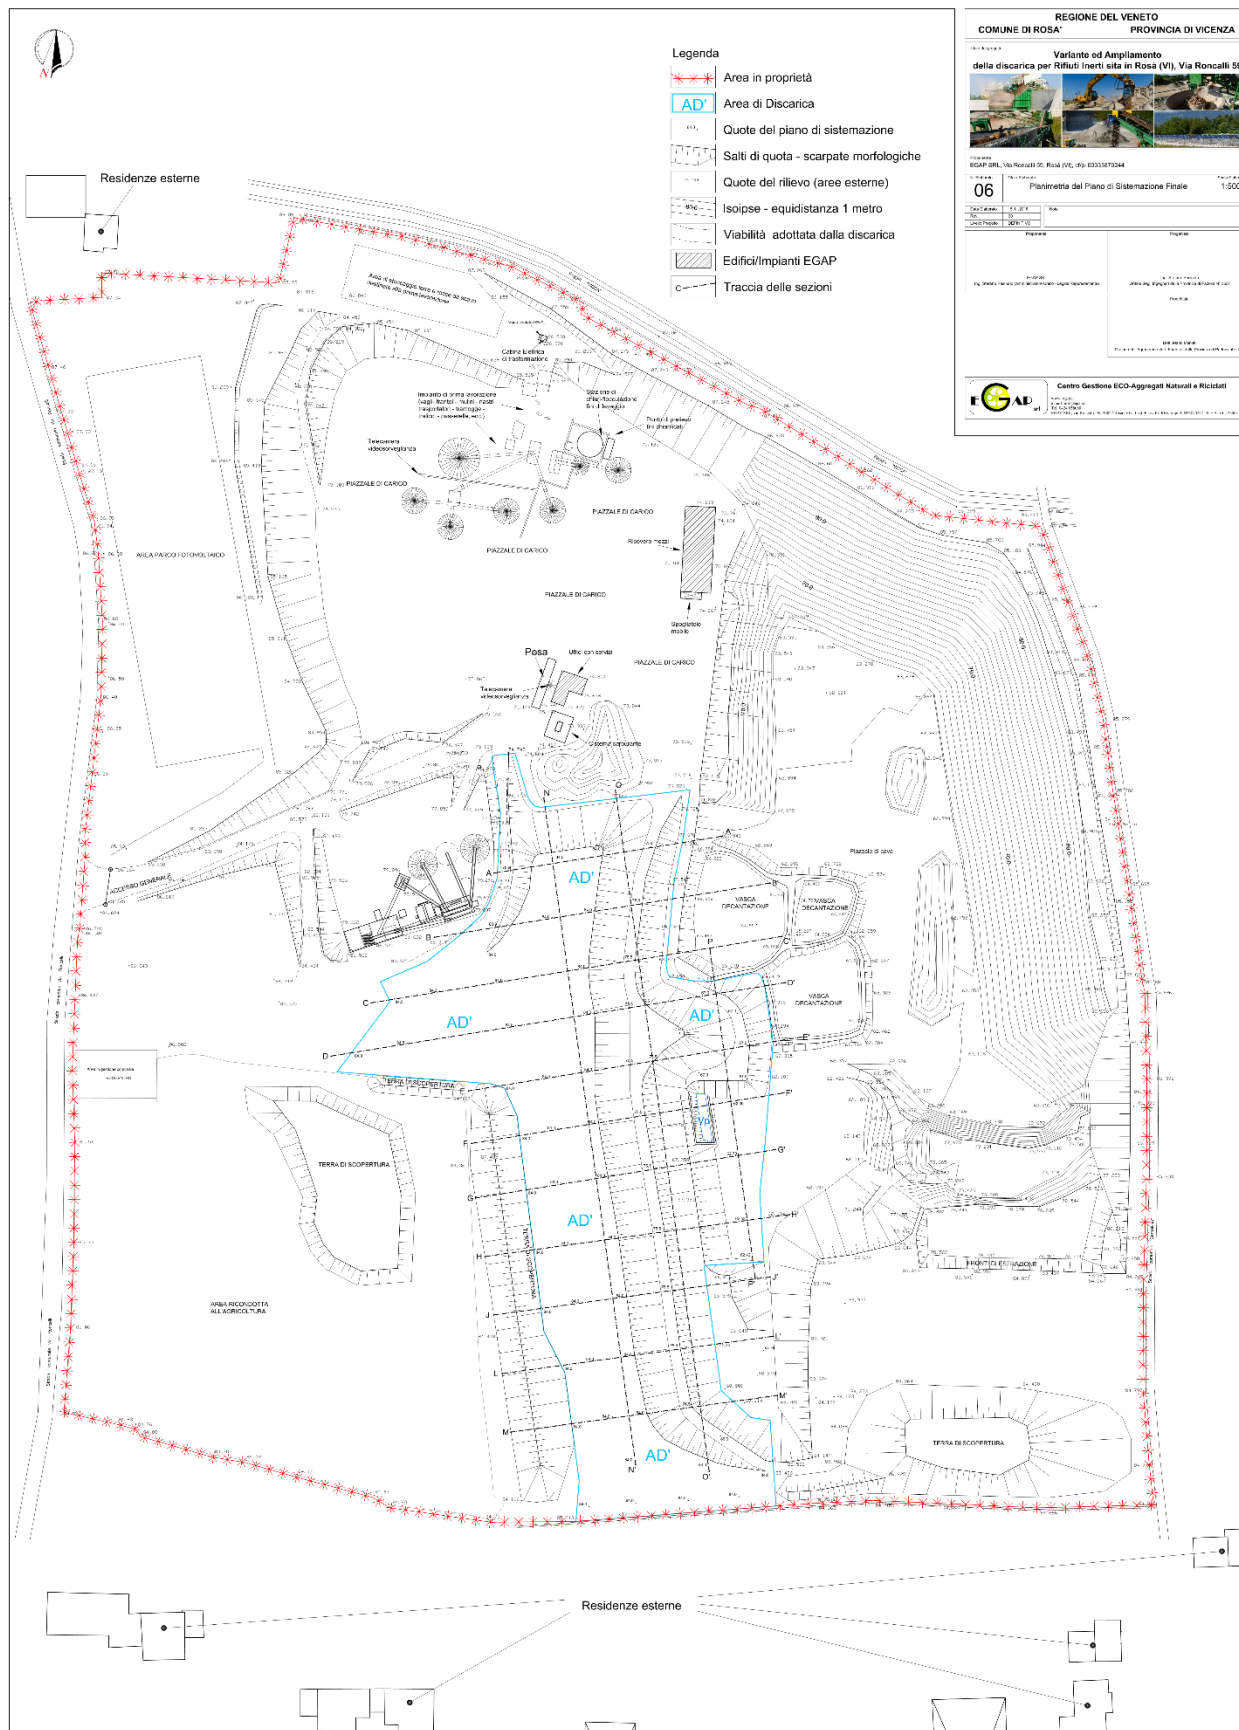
Piano di Sistemazione Finale. Intera Area. Elaborato n. 06 – PLANIMETRIA DEL PIANO DI SISTEMAZIONE FINALE
